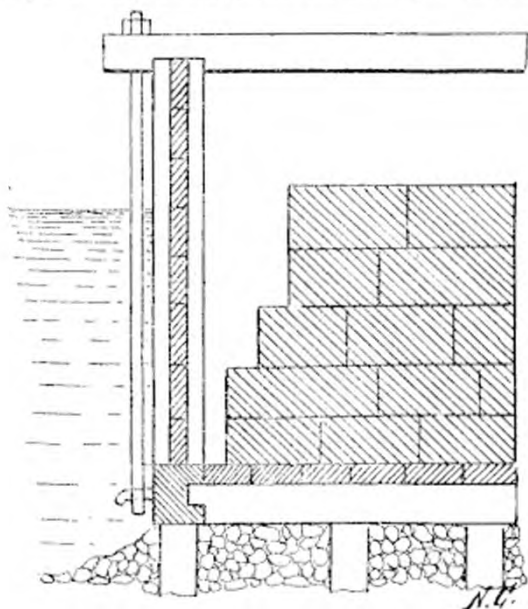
Fondations dans l'eau à l'aide d'un caisson de bois.
